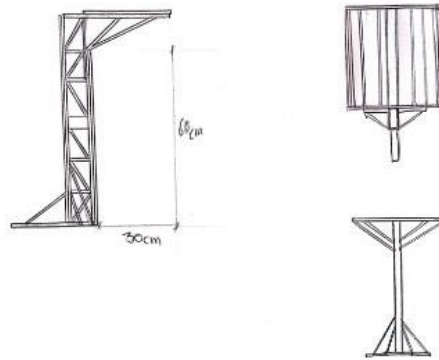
Alzado del boceto definitivo con vistas de planta y perfil
